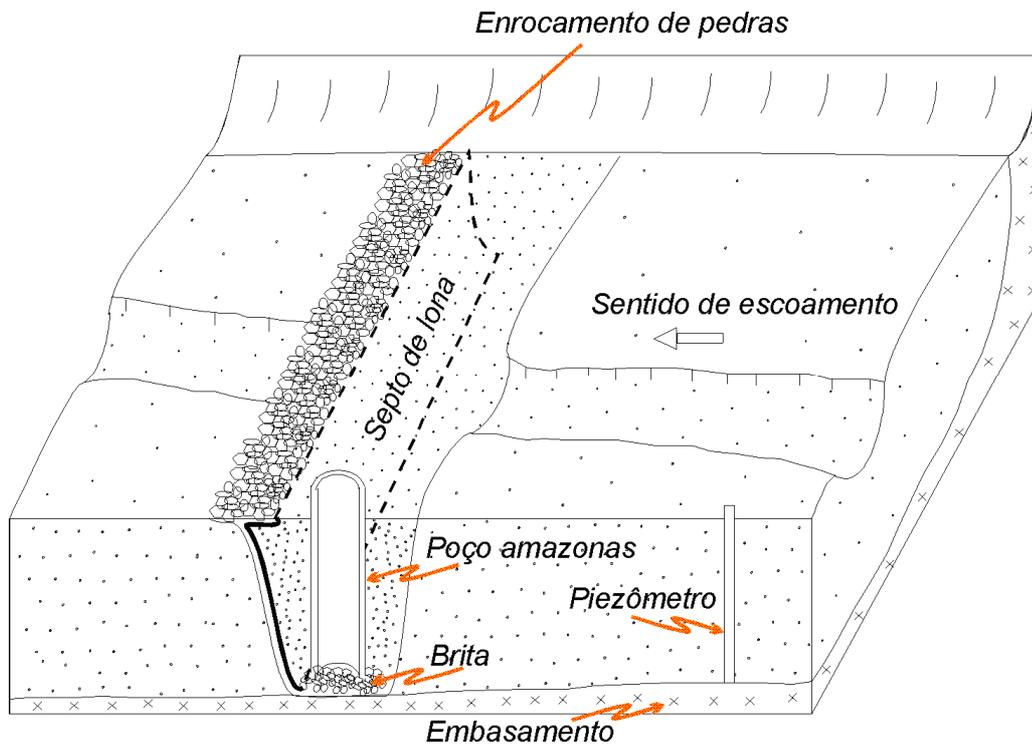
Esquema de barragem subterrânea com captação em poço amazonas
